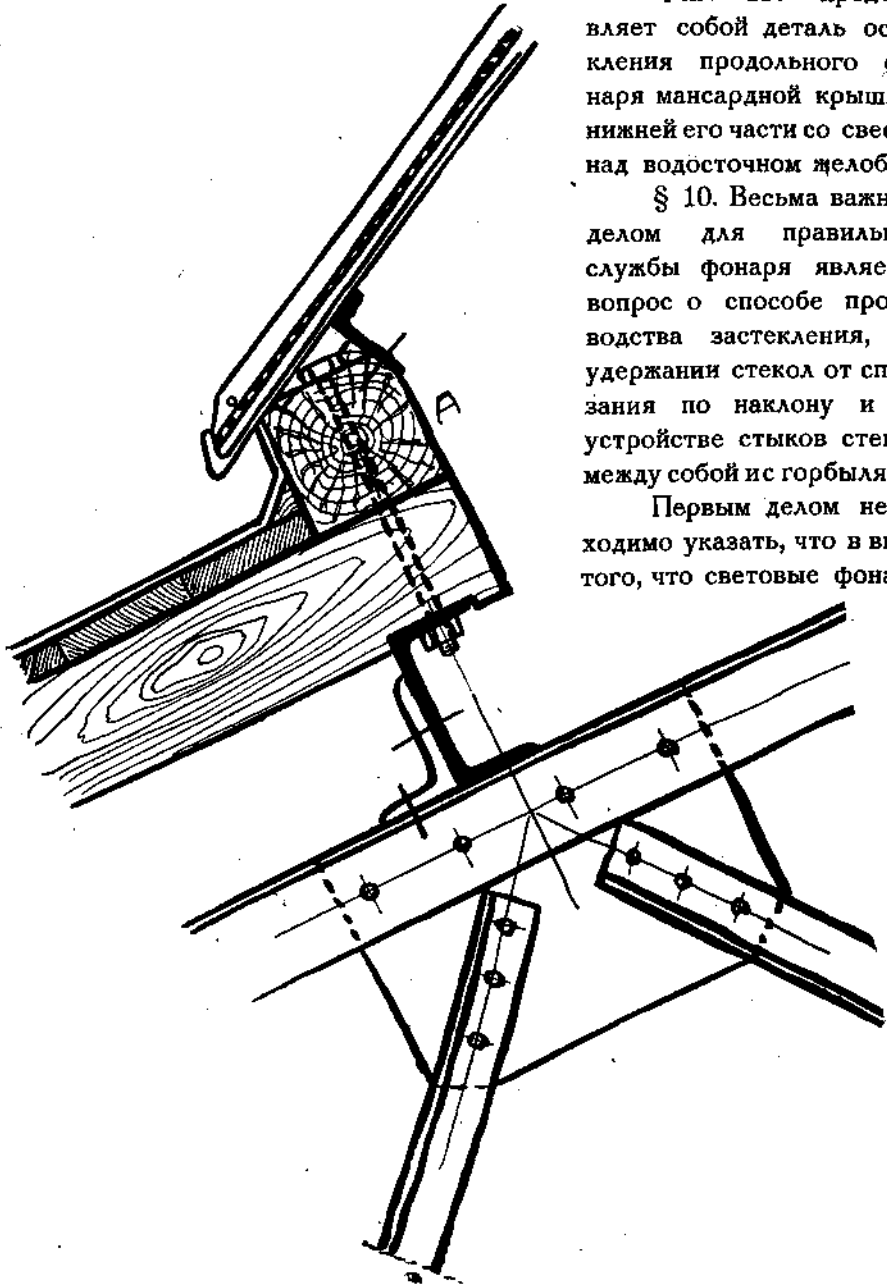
устройство свеса светового фонаря на железных стропильных фермах, но с деревянным строением кровли. Возвышение фонаря над кровлей и образование необходимой стенки произведено при помощи деревянного бруса А, прикрепленного к металлической поперечине болтом. Укрепление металлических горбылей остекления сделано
